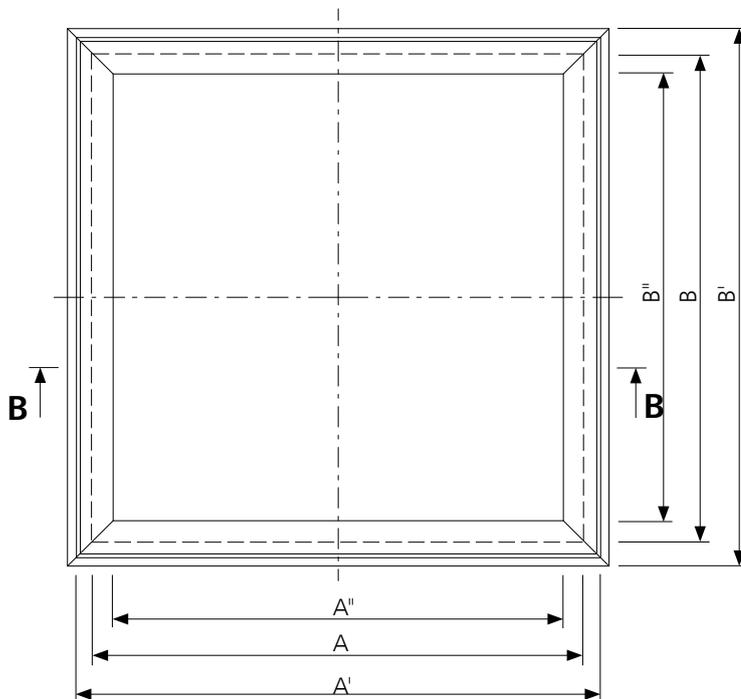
Draufsicht von einem Dachausstieg mcr ULTRA THERM Typ NG-A in geschlossener Position
